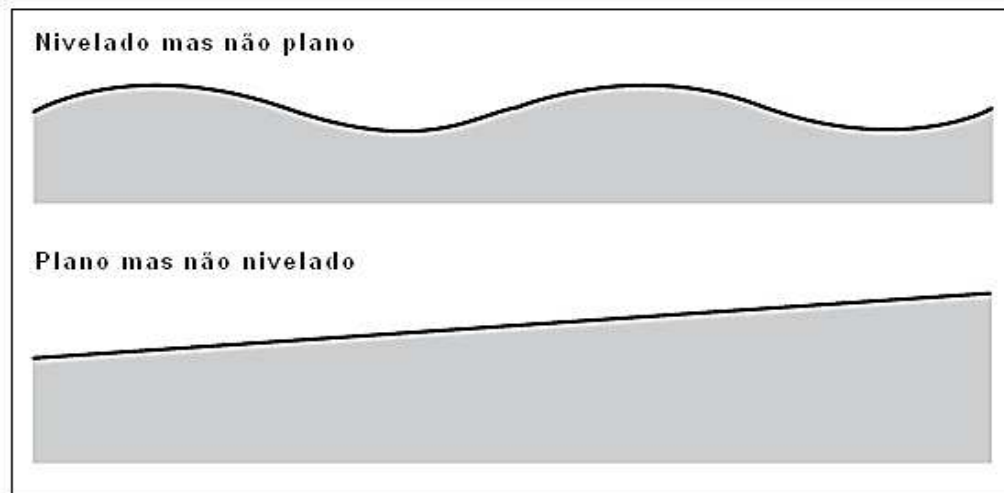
Esquema elucidativo do Nivelamento e da Planimetria (adaptado de Concrete Society, 2014)
